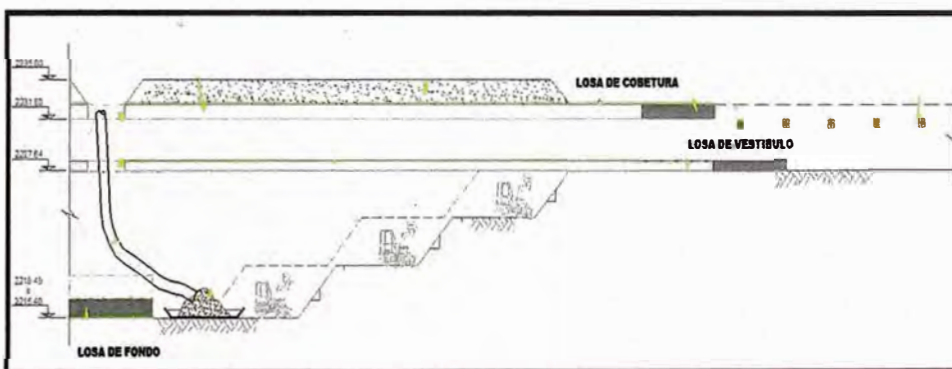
Esquema de excavación y construcción de losas de la estación Mexicaltzingo.
